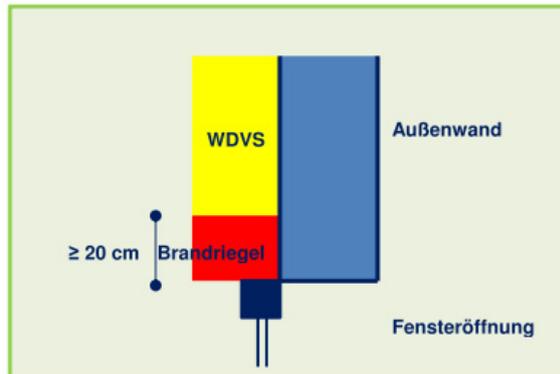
Ausführung »Brandriegel« bei Passiv-Häusern
